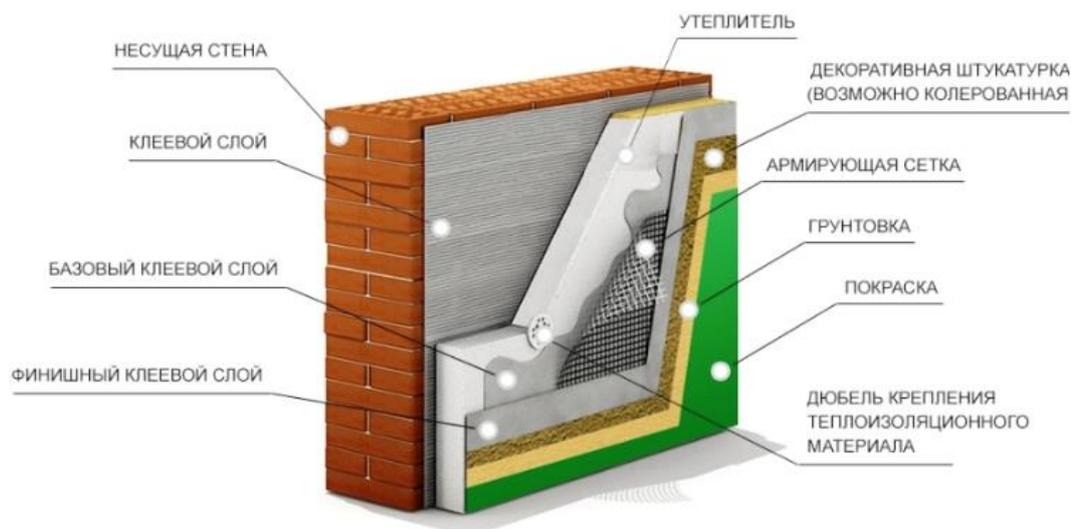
Конструкция наружной стены здания, выполненной по технологии «мокрый фасад»
